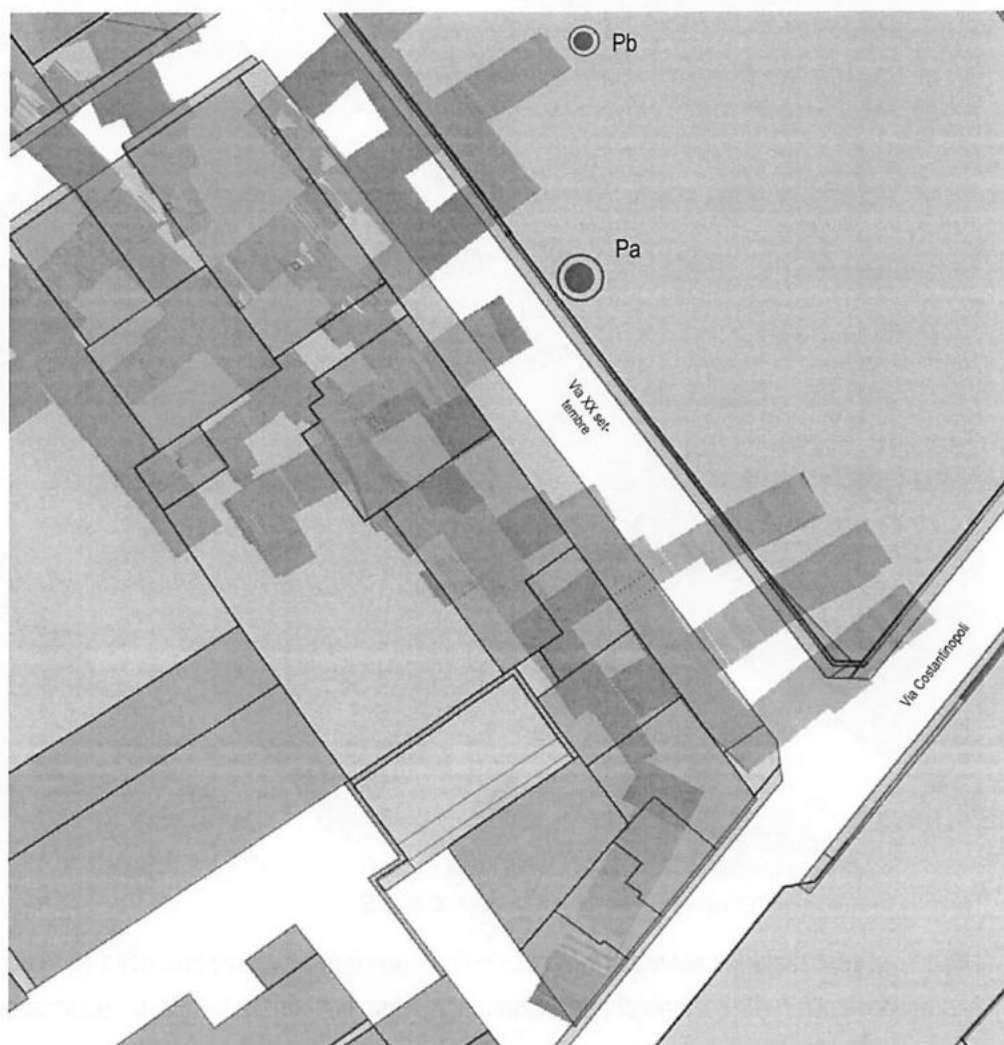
CAVITÀ 73 – POSIZIONE POZZI PA E PB NECESSARI ALL'ACCESSO ALLA CAVITÀ E ALL'ESECUZIONE DEGLI INTERVENTI DI RINFORZO.
